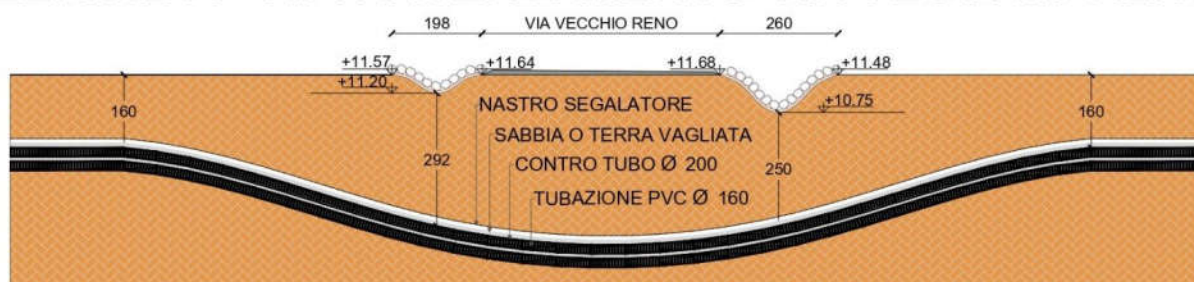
Tratto F-F' – Sezione attraversamento Via Vecchio Reno
